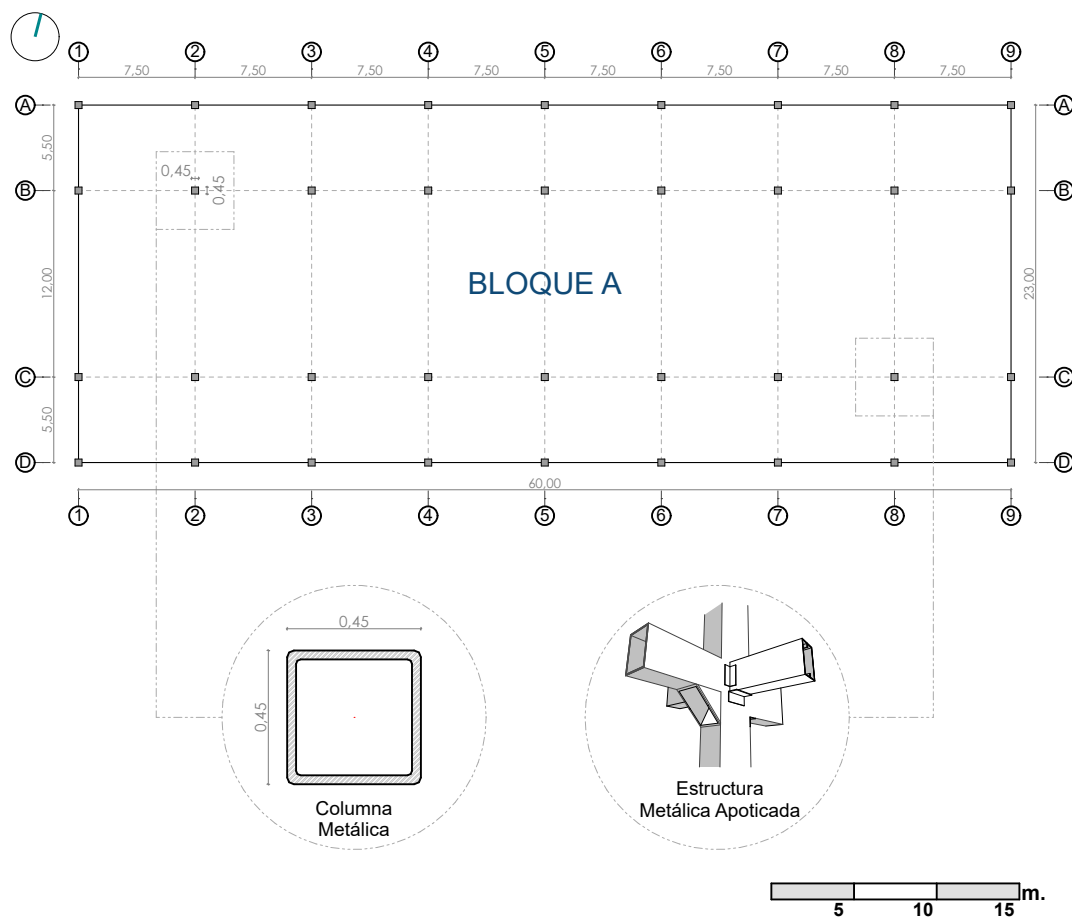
Definición de estructura metálica. Elaboración: Autor.
